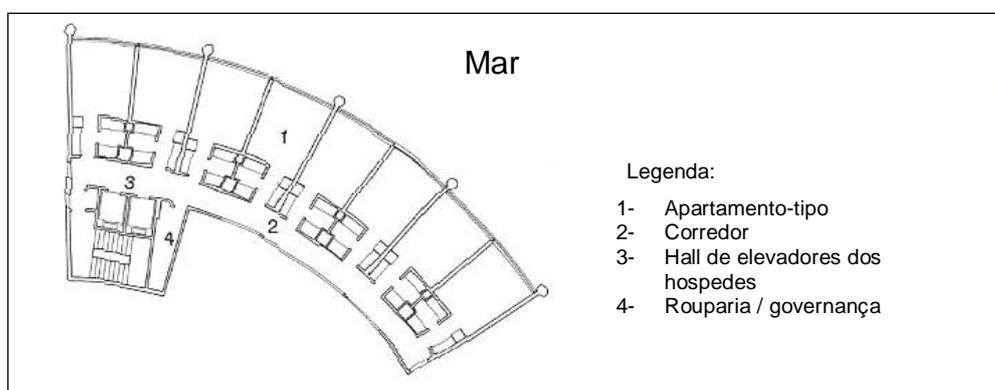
Planta Baixa Hotel Saint Paul, São José do Rio Preto.
